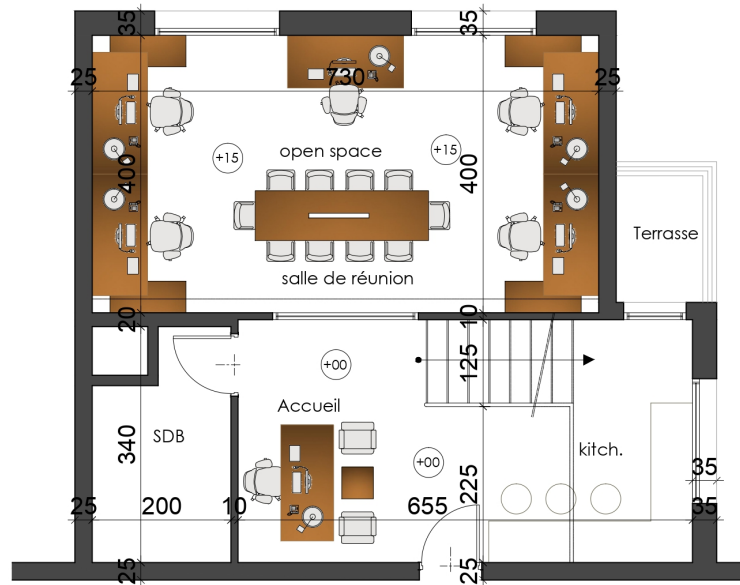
Nouveaux plans de niveau et d'élévation
